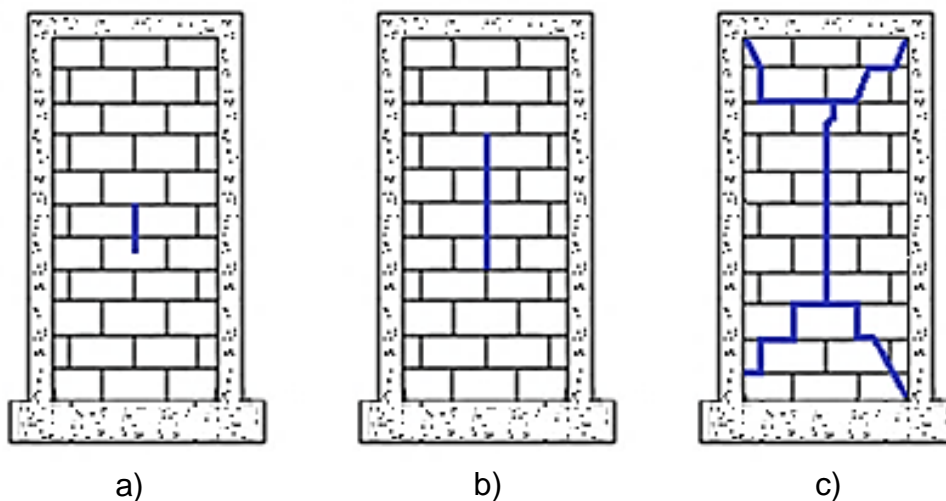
Patrón de agrietamiento del muro M-2.0-0.
